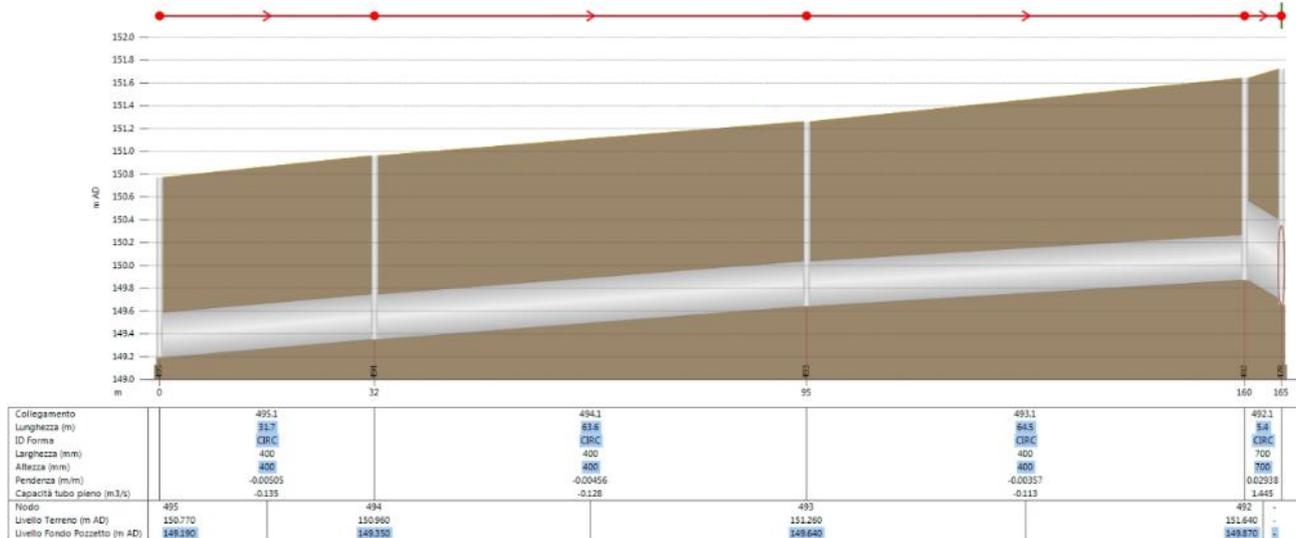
Profilo tubazione esistente via Magellano, dalla camera 495 alla camera 478
